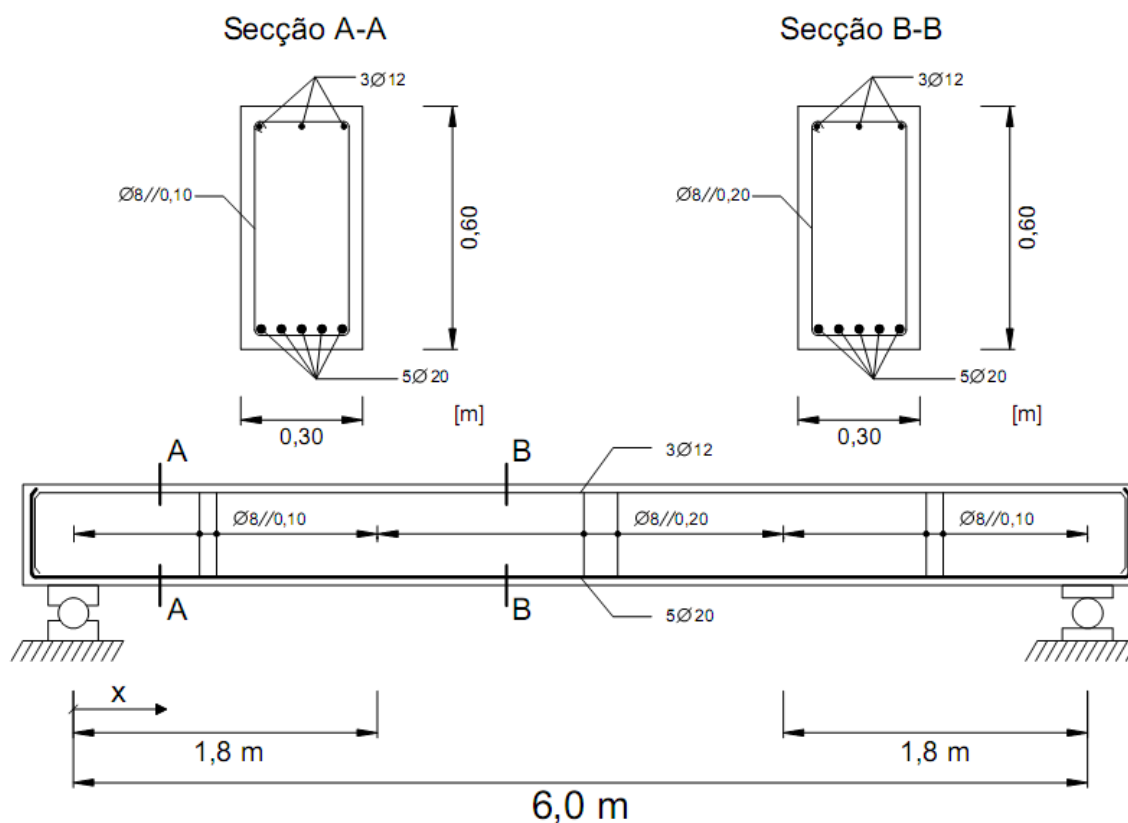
Pormenorização da armaduras (Caso A – secção retangular)
